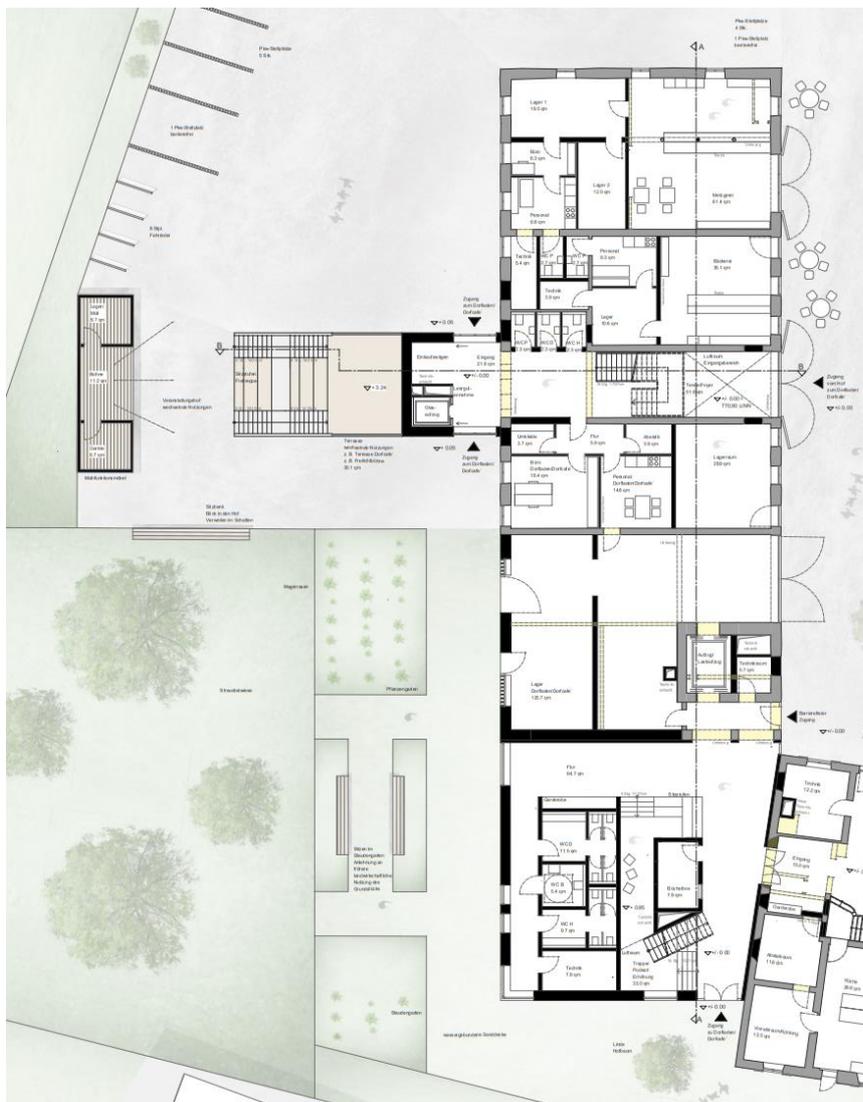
neuer Grundriss Erdgeschoss Stadel + Anbau
